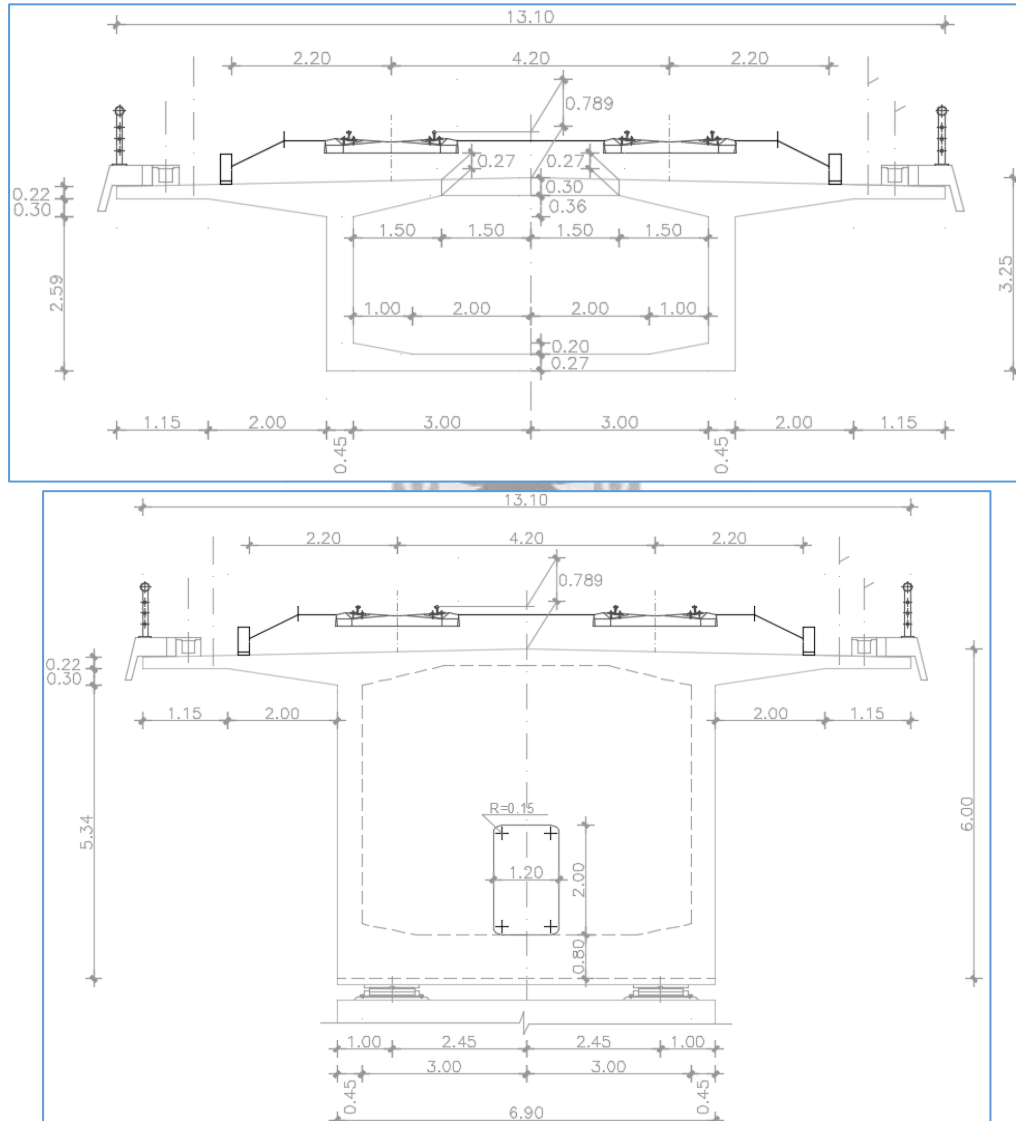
Sección preliminar tipo para viaducto. Fuente CAC
